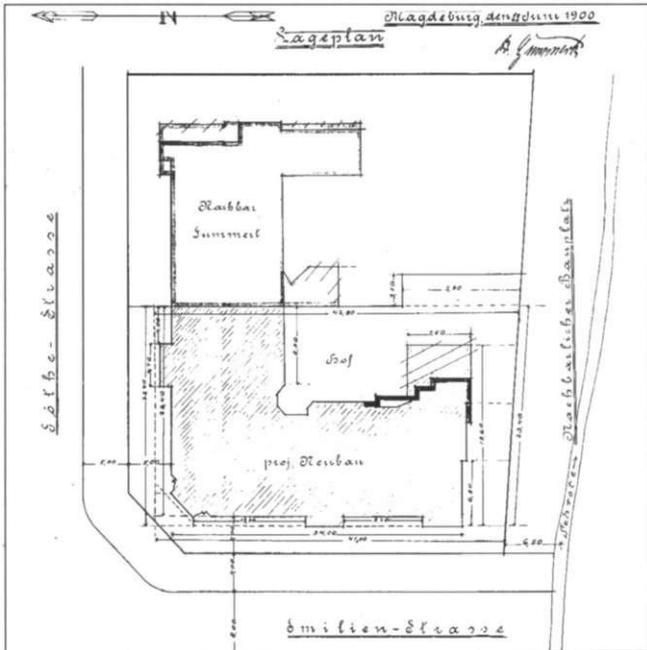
Goethestraße 39, Lageplan mit Schroteverlauf hinter dem Grundstück, das Nachbargrundstück Goethestraße 40 ist zur gleichen Zeit vom selben Bauherrn bebaut worden
